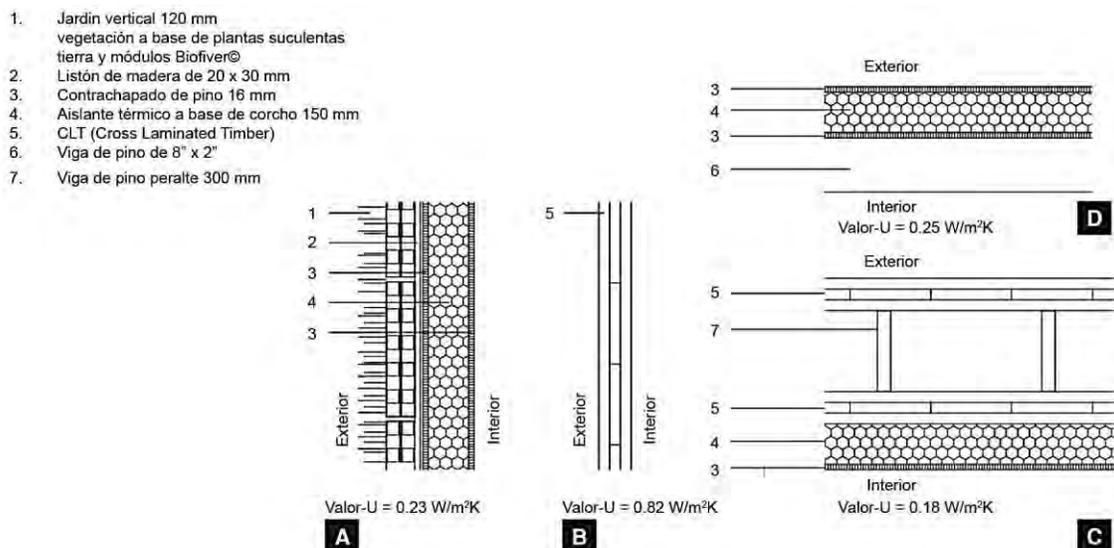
Detalles de los componentes de la envolvente. A) Sistema de plataforma en muro con jardín vertical. B) Sistema de CLT en muro. C) Piso de toda la casa. D) Techo.
